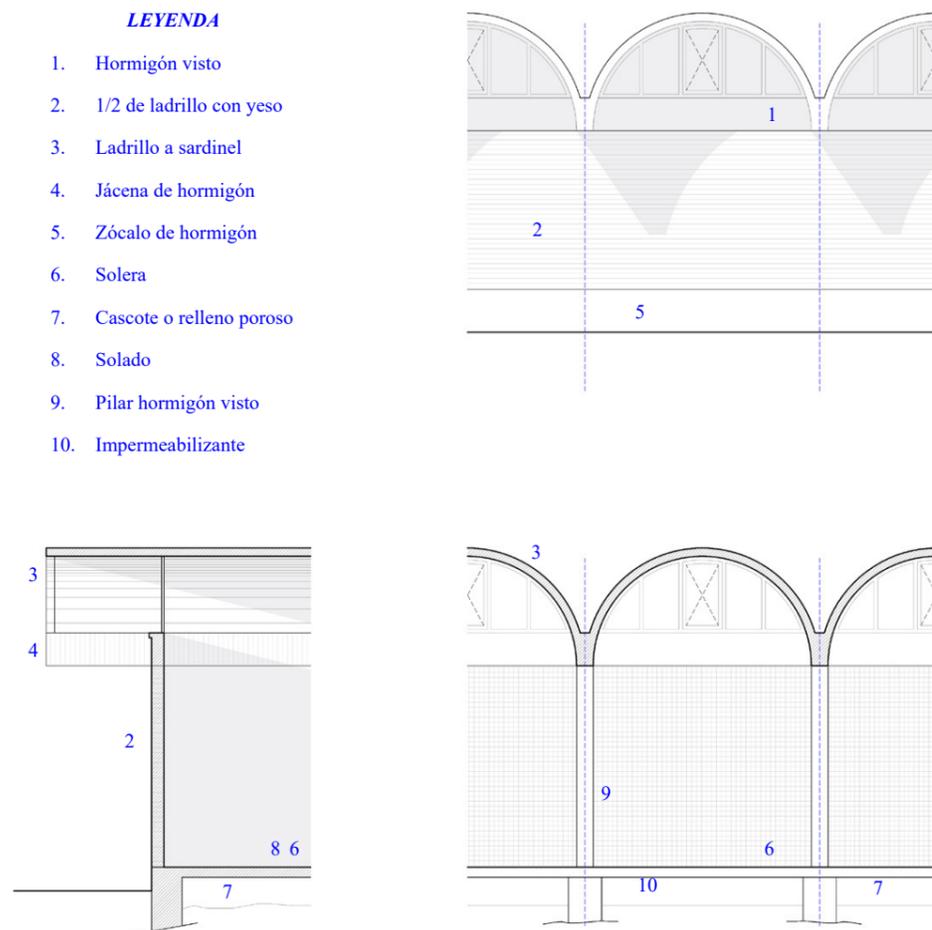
De arriba a abajo y de izquierda a derecha: Alzado exterior, sección de la fachada por hueco del tímpano, alzado interior, escala 1:50
